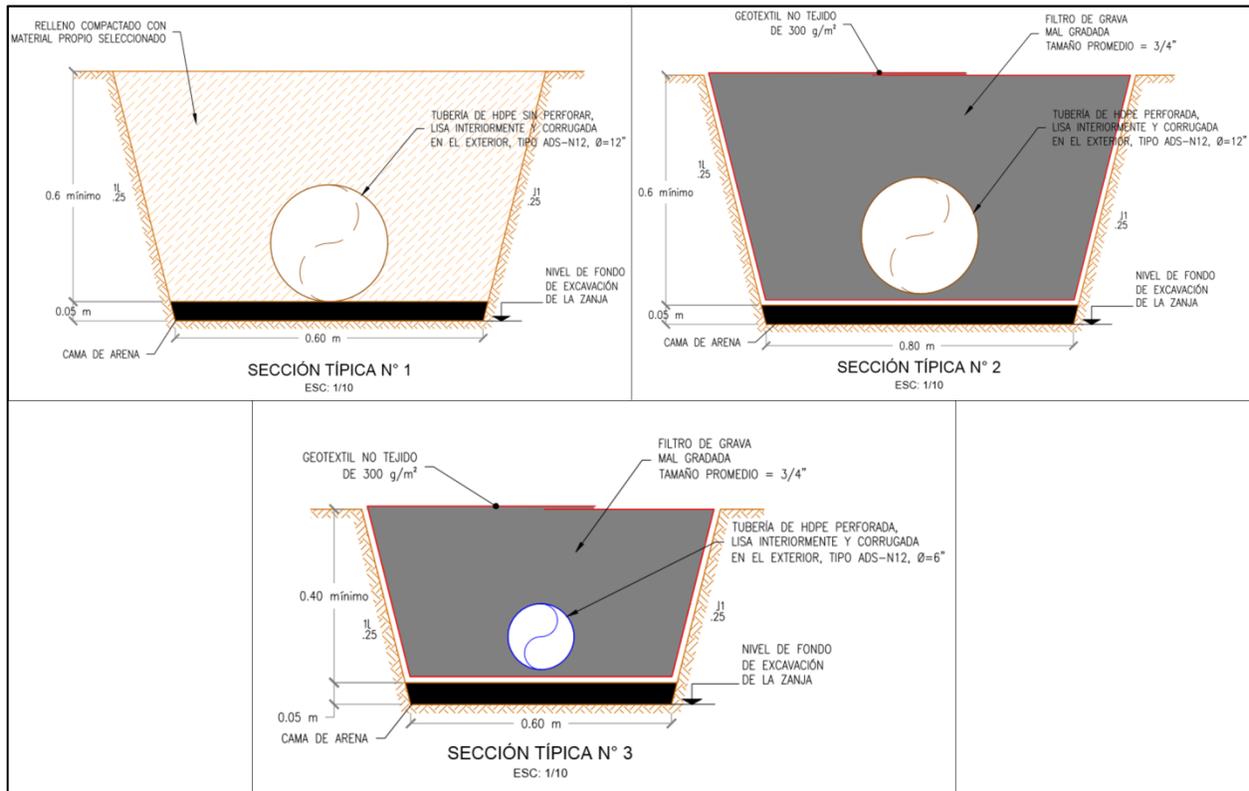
18. Esquemático de secciones de sistema de drenaje interno
